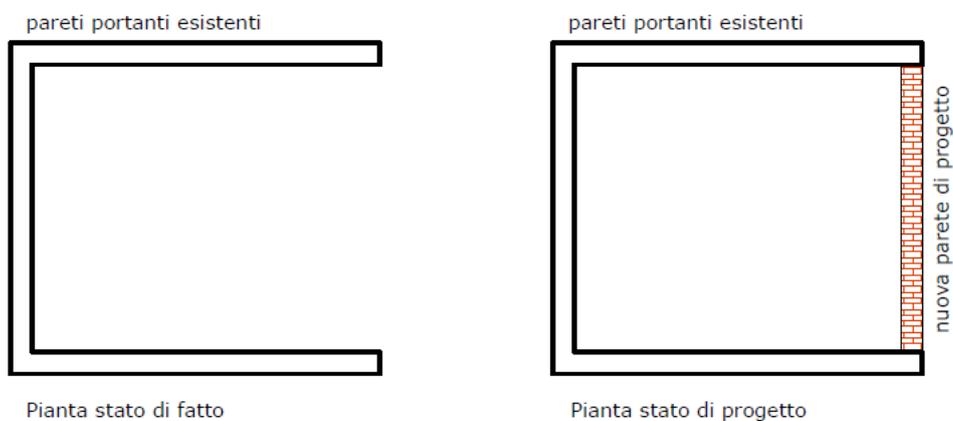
Inserimento parete portante di richiusura scatola muraria
